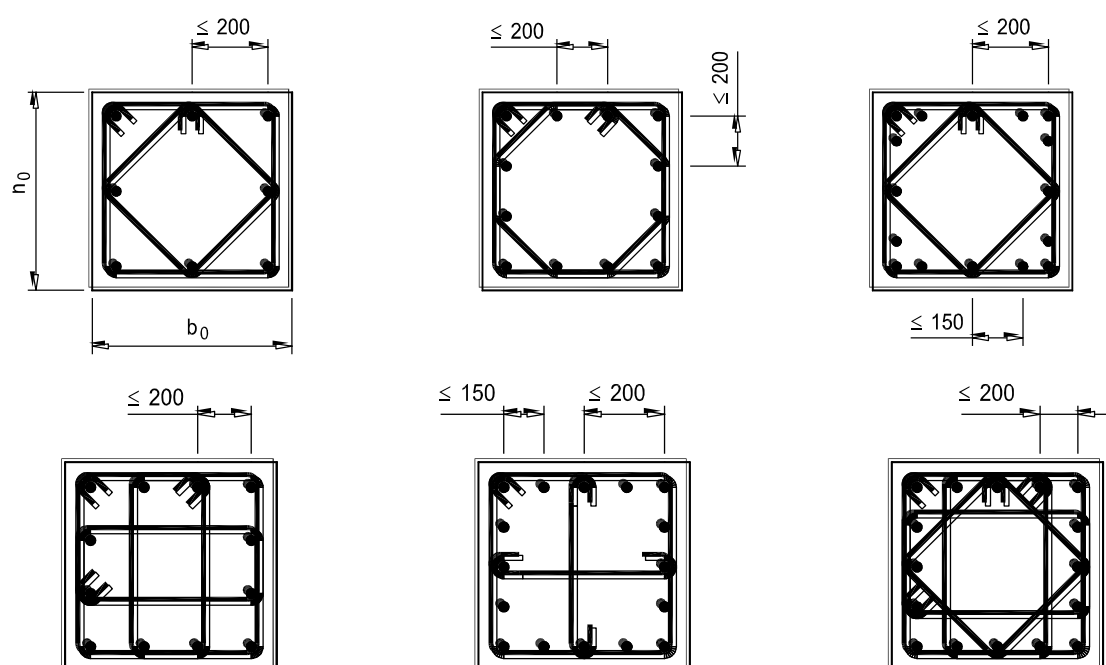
Принципиальные схемы поперечного армирования колонн конструктивных систем класса DCM
